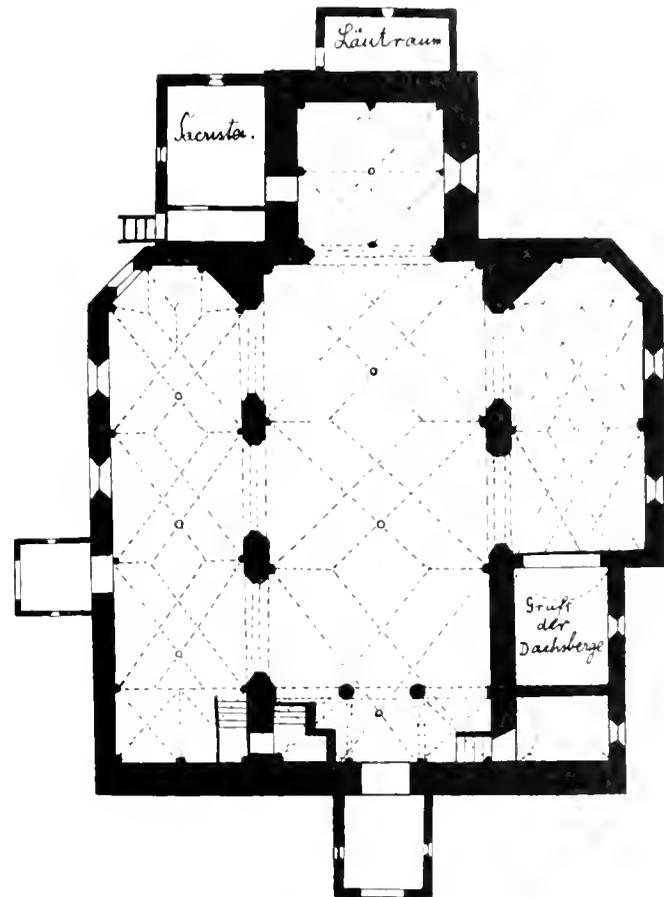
Grundriß der Pfarrkirche zu Rapotenstein
